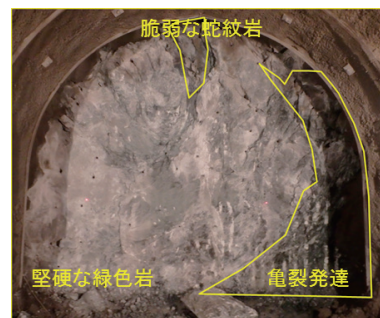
切羽状況 (Fig.3 の切羽) (Situation of a Tunnel Face(same as Fig.3))
